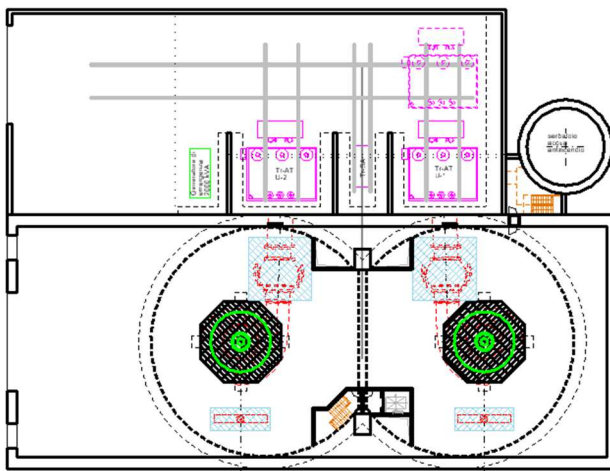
Pianta del piano -263,30 (estratto Tavv. PD-EP.18.2).
